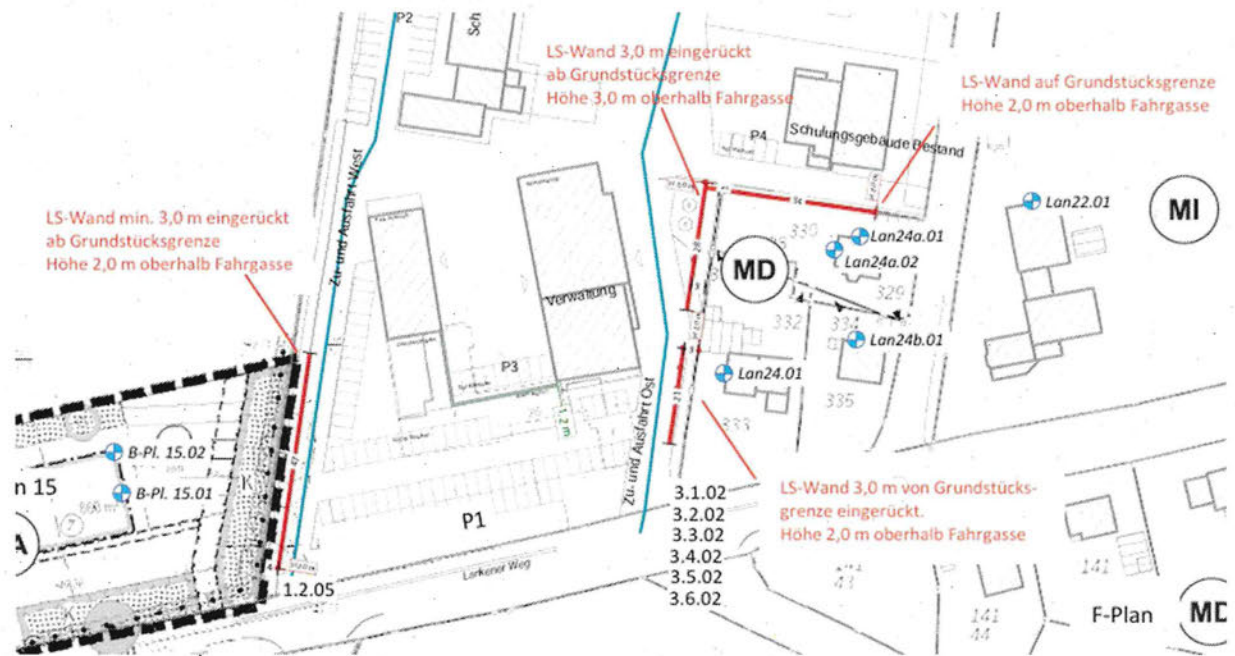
Planfall 3b - Sonderbetrieb LZ-G mit Lärmschutzmaßnahmen Variante 1
